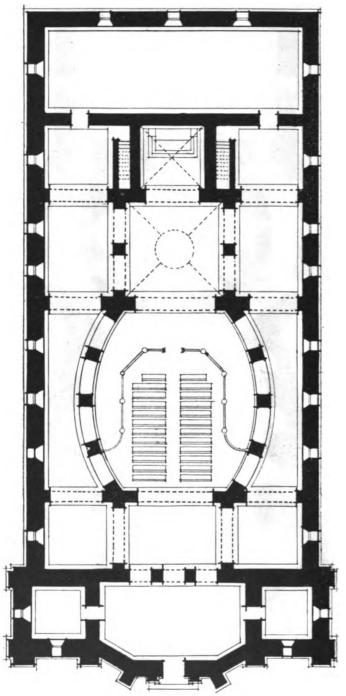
Ouro Preto. — Planta aproximada de sa "Matriz del Pilar"
